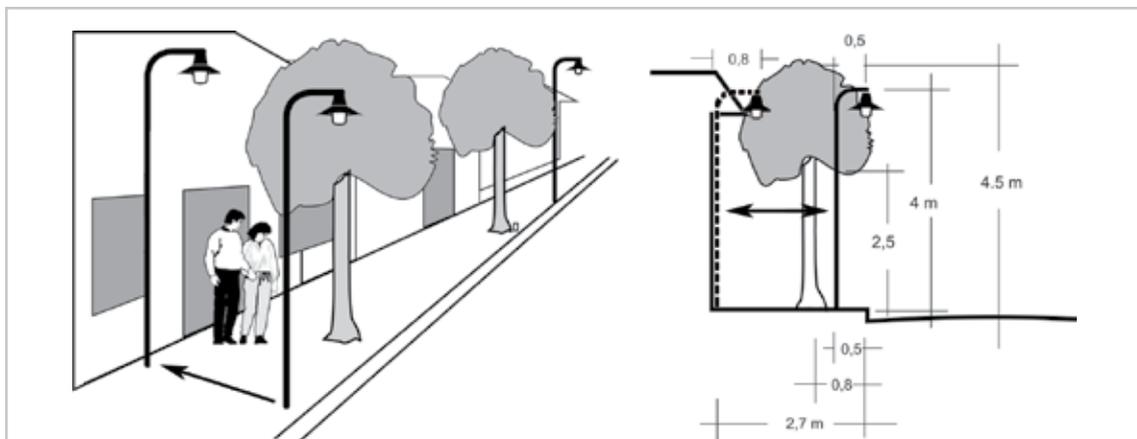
Instalación para pasajes con calzadas de 6-7 m de ancho.
